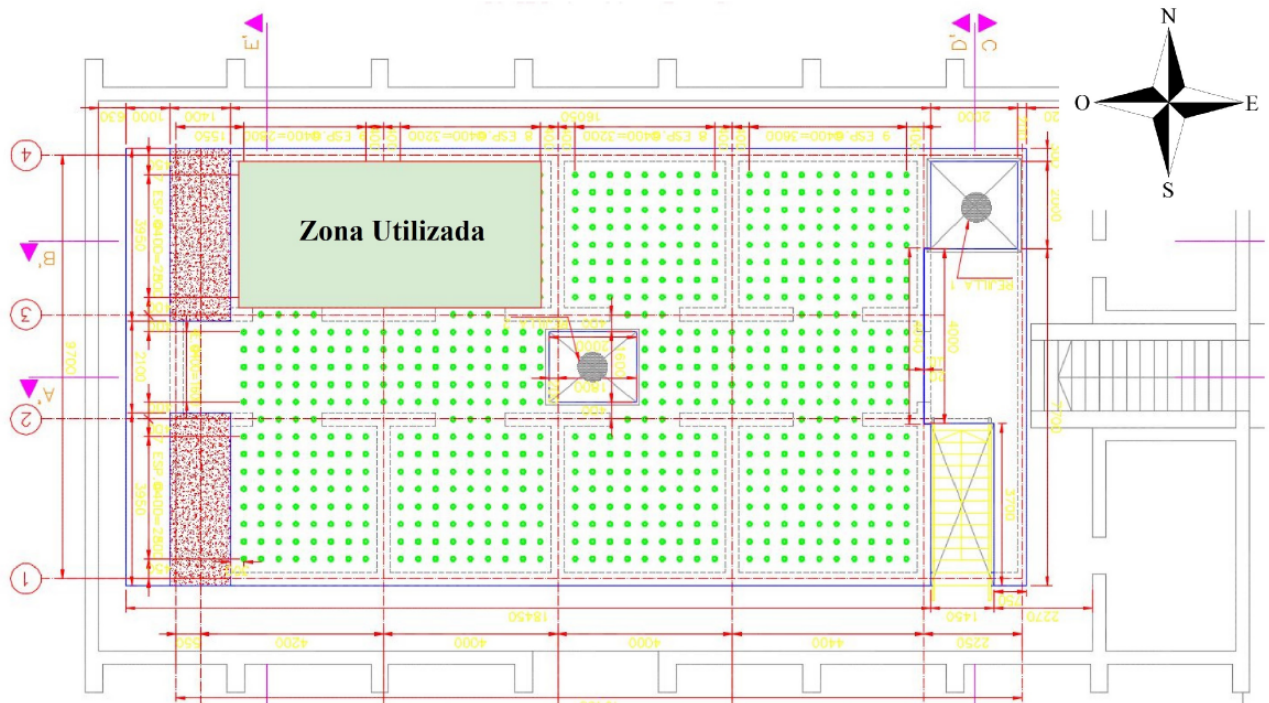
Plano General Laboratorio de Estructuras [17]
